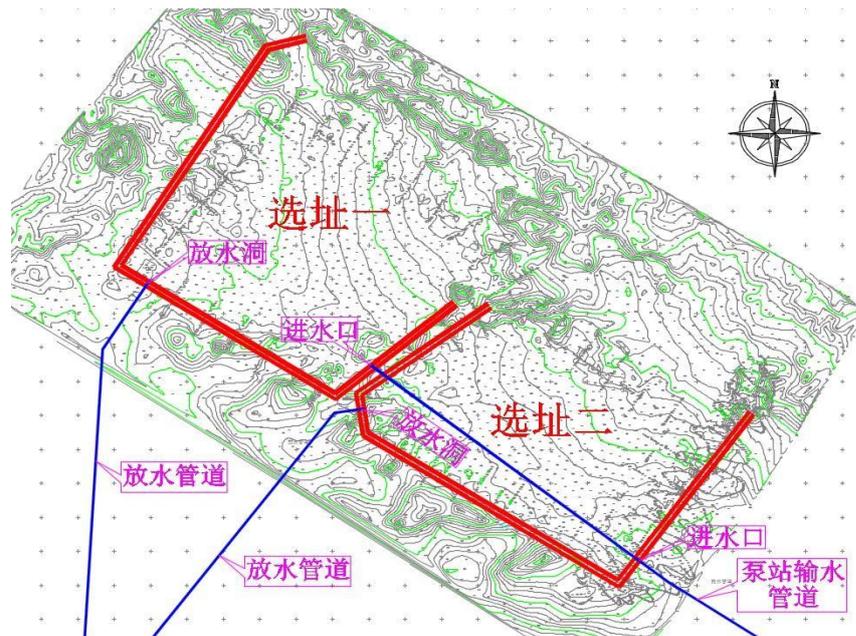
本项目调节蓄水池选址方案比选平面布置图
